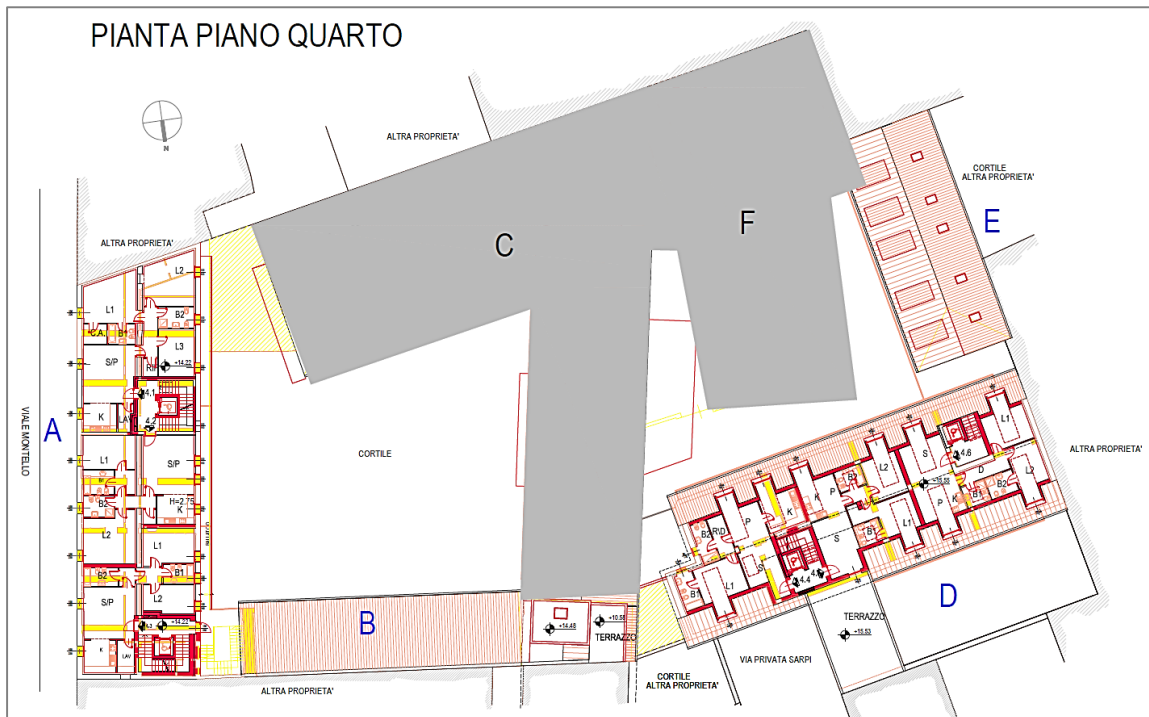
Pianta piano quarto dei blocchi A, B, D, E.
